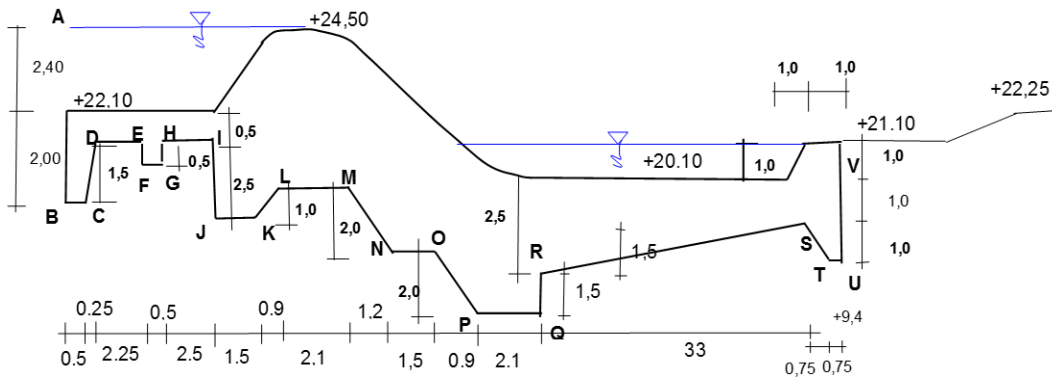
Denah konstruksi Bendung Kamijoro
